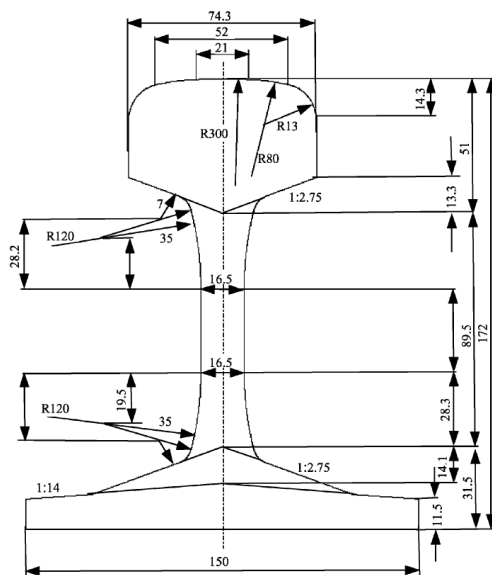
Dimensions en mm de la section du rail UIC 60
